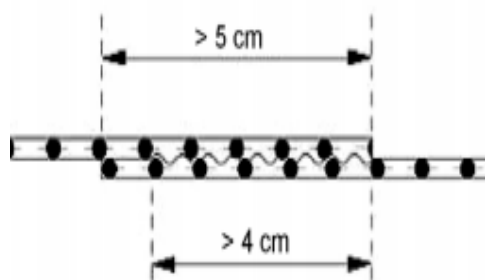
Solapamiento longitudinal y transversal. Fuente: Figura 21 Norma UNE 104416:2009
